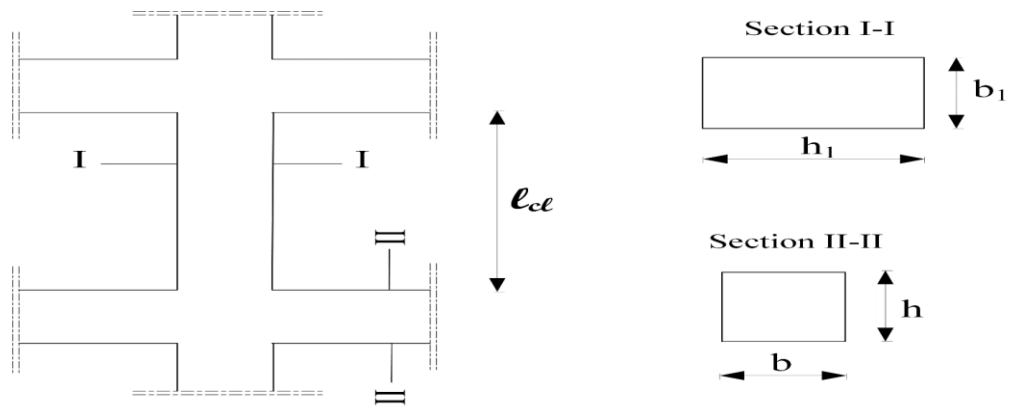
Coffrage des poteaux. (Art, 7.4.1, P61, RPA 2024).
